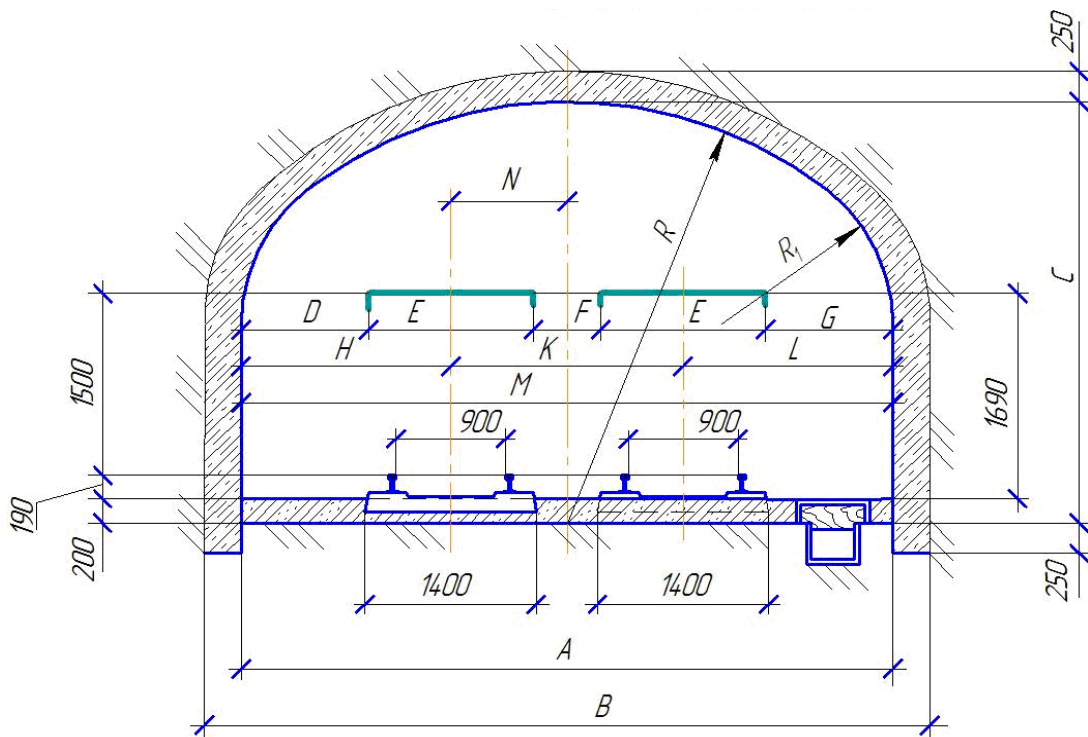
Типовое сечение арочной выработки закрепленный бетоном
